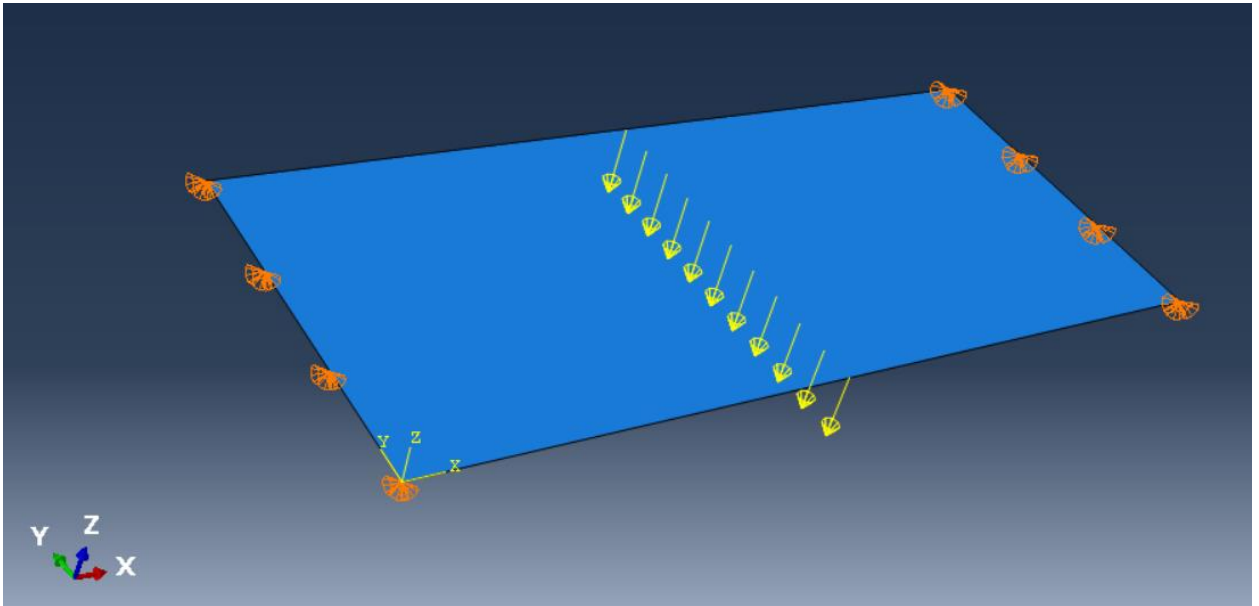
Оболочка сплошной плиты перекрытий с заданными нагрузками
